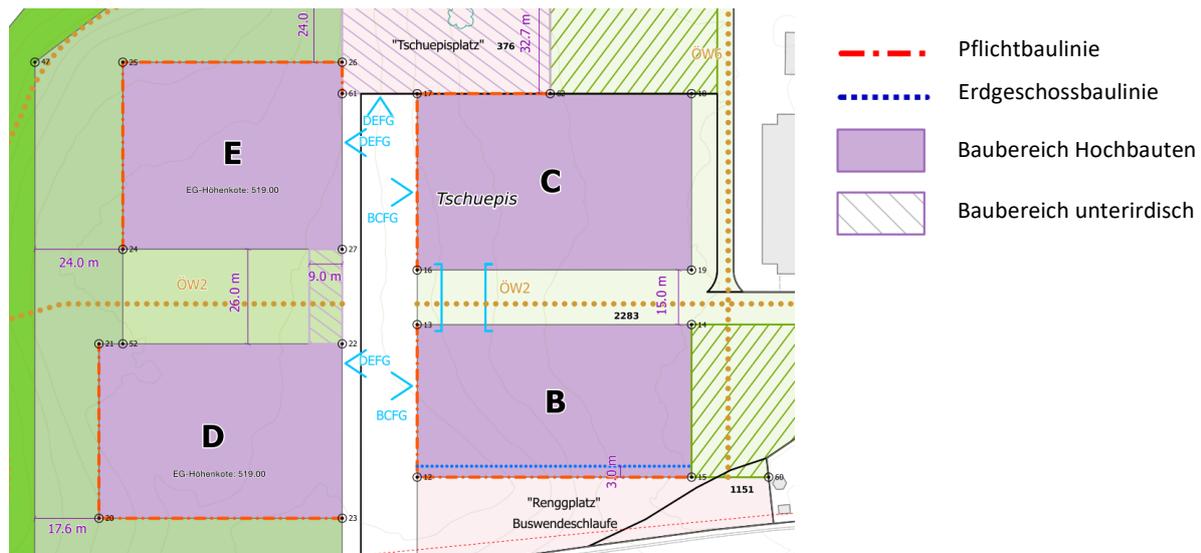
Ausschnitt Bebauungsplan, Baulinien und Baubereiche
